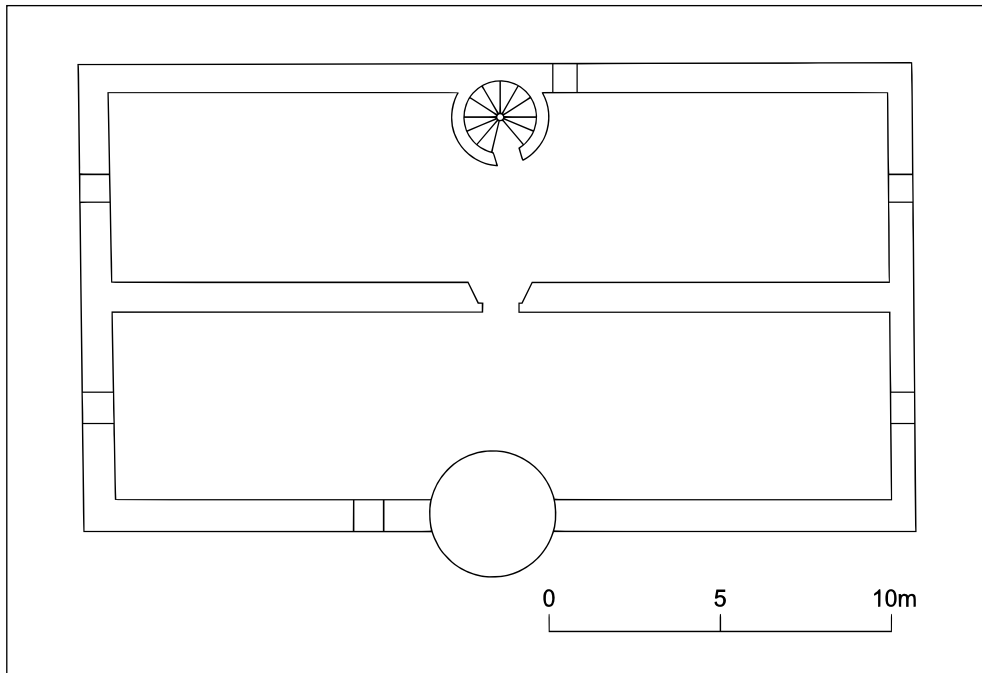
Jessen (Elster), Schloss Glücksburg, Kellergeschoss, Grundriss
